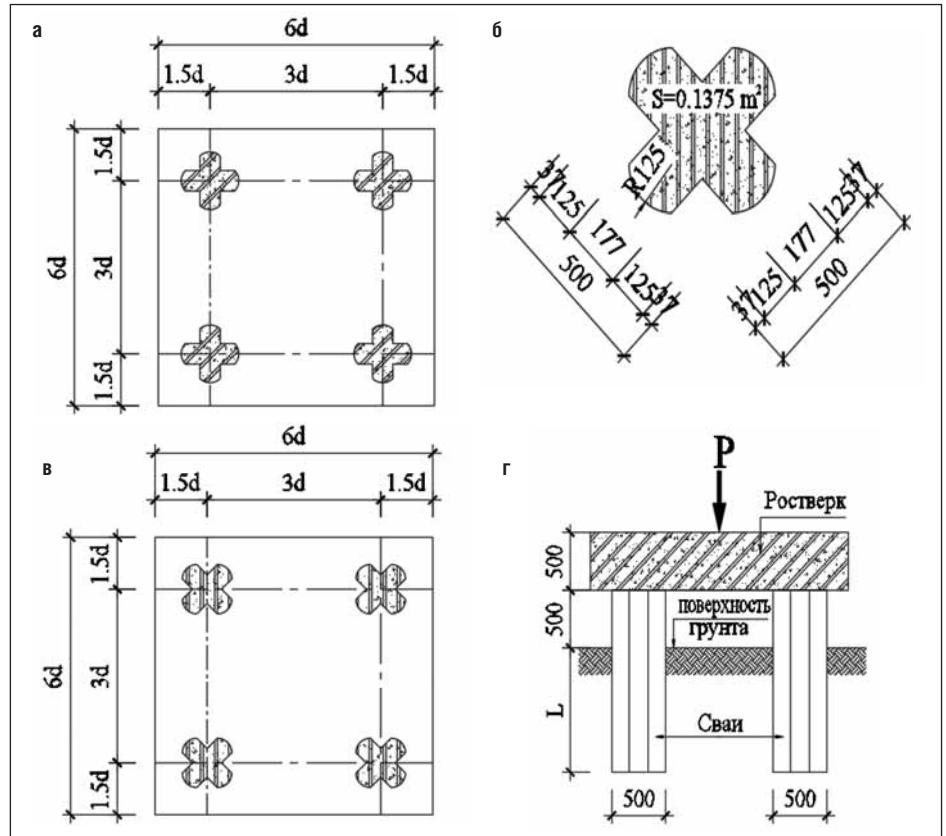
Расчетная схема куста из четырех свай: а – без поворота свай с расширением вдоль тела (вариант 2); б – размеры поперечного сечения сваи с ее углом поворота 45°; в – с углом поворота свай 45° и расширением вдоль тела (вариант 1) ; г – размеры поперечного сечения свайного фундамента
